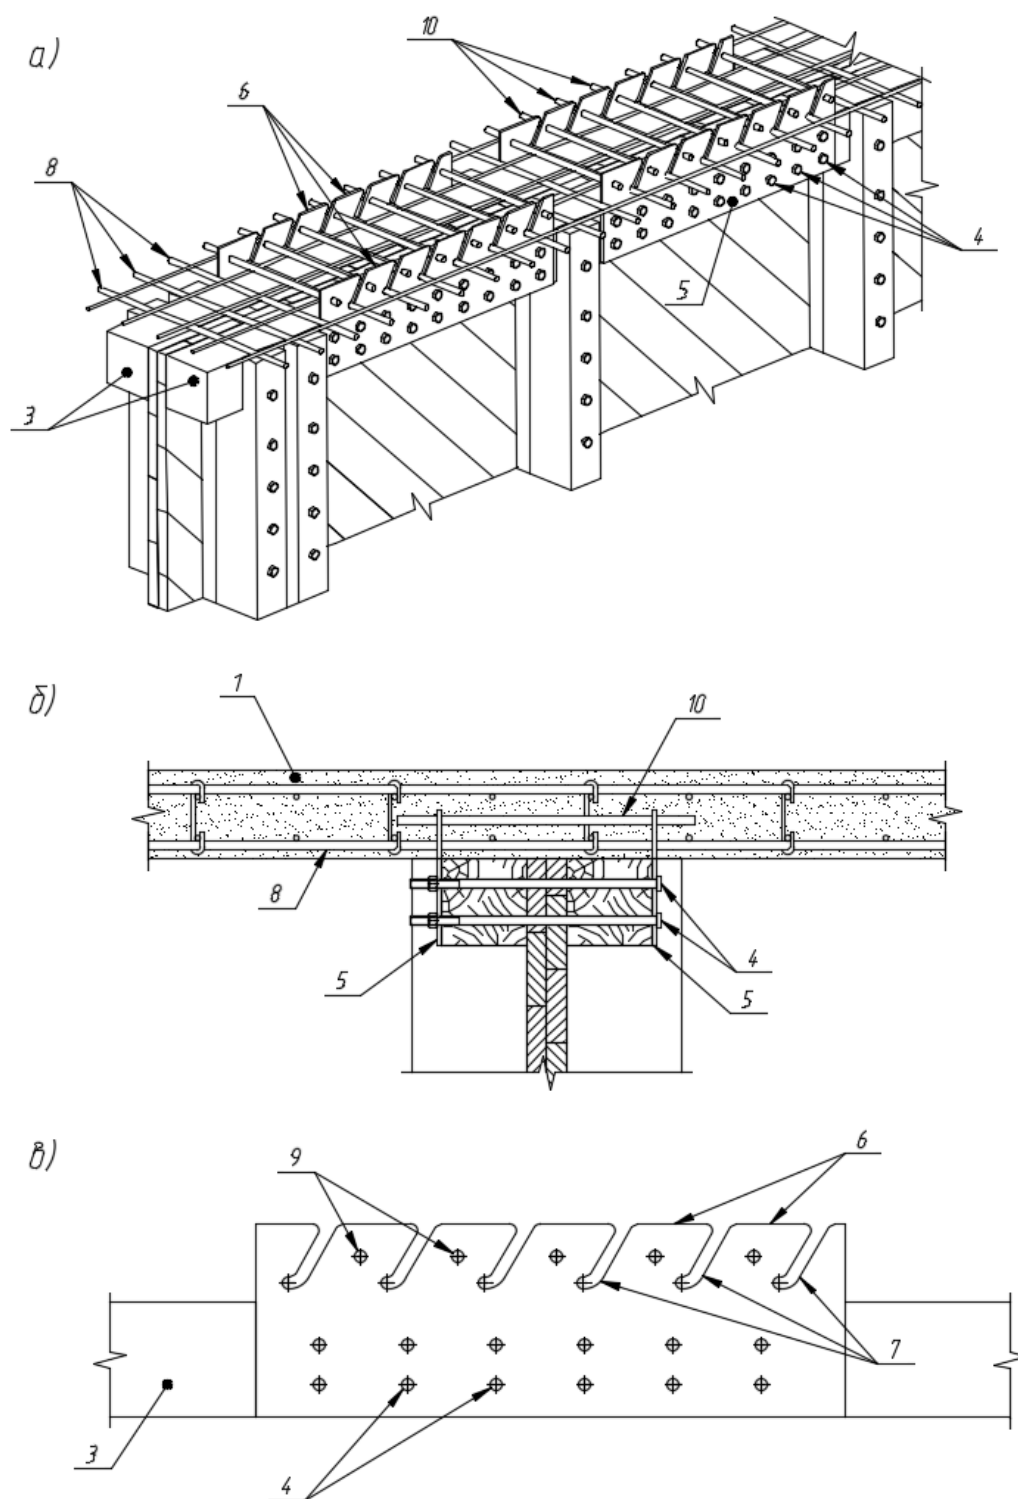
Конструкция узла №1 объединения железобетонной плиты и ДГБ:
